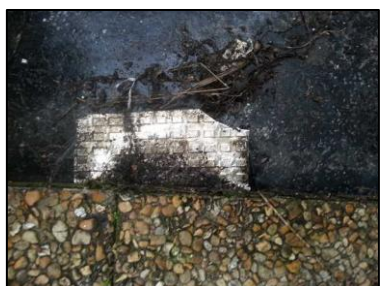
ECH-N°033 Bâtiment 21-4ème-Appartement 21043 Terrasse Paxalu
